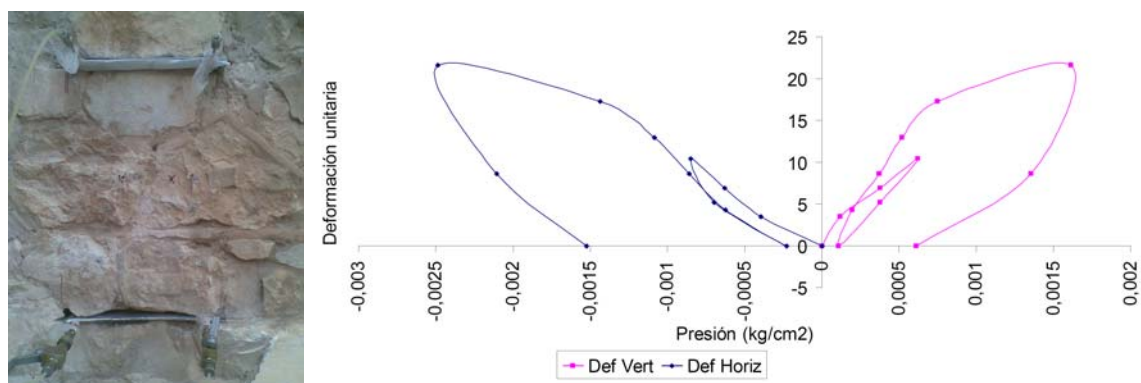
Ensayo de gato plano doble n° 2 en un muro de mampostería exterior (Cortesía de Aidico).
